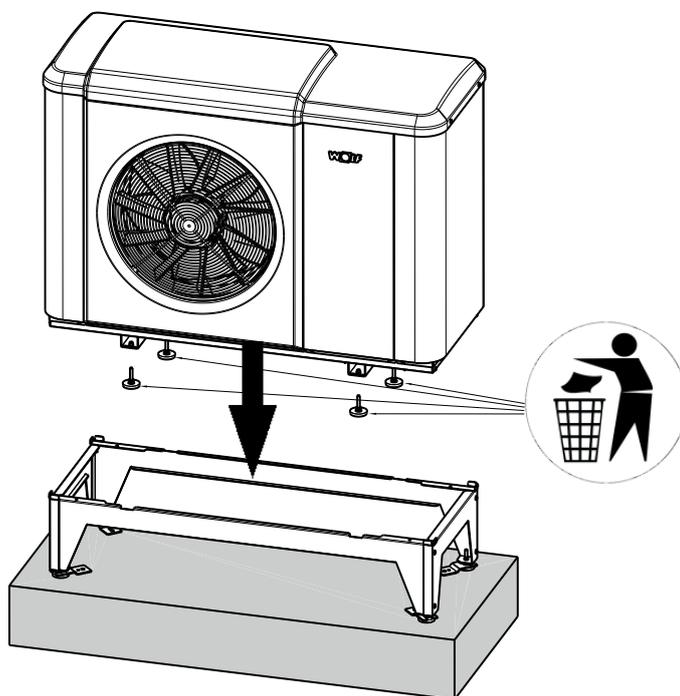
Montare l'unità esterna sul rialzo a pavimento
